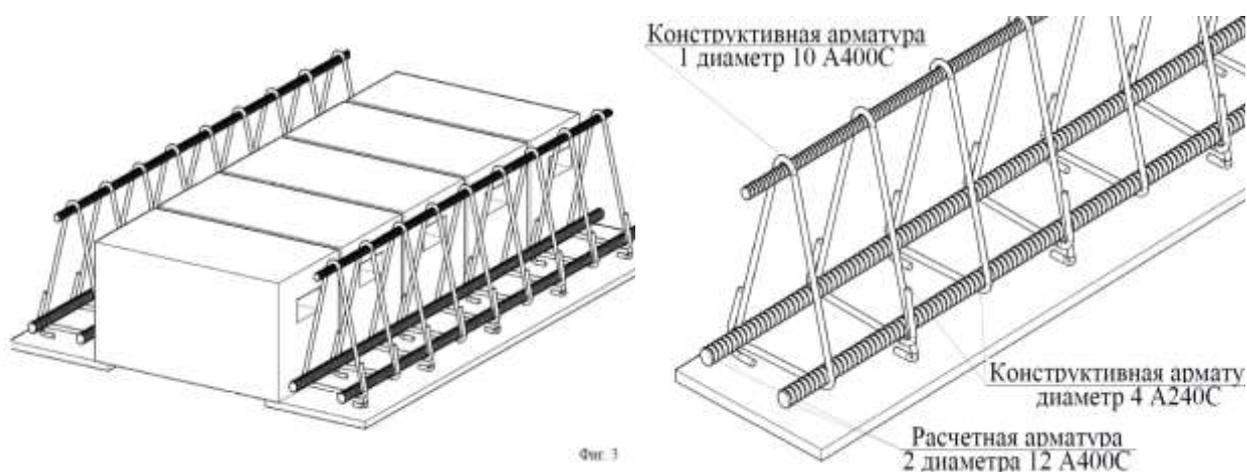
Предлагаемый элемент монолитного бетонного перекрытия и его армирование
